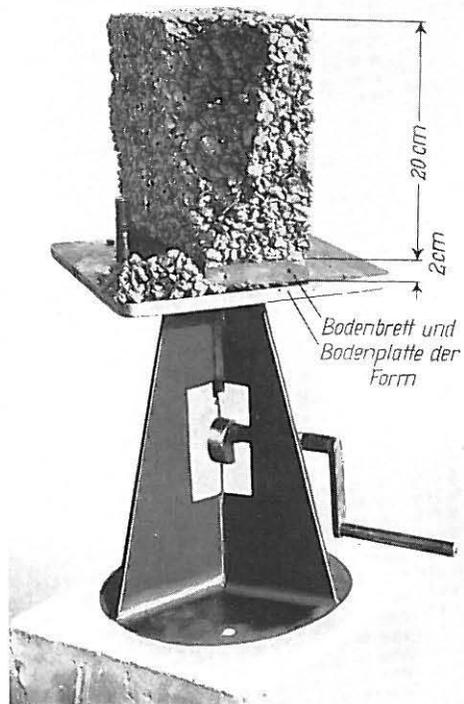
Schocktisch mit einer Probe aus Ziegelsplittbeton 7/15 mm (nach 10 Aufschlägen eingestürzt)
